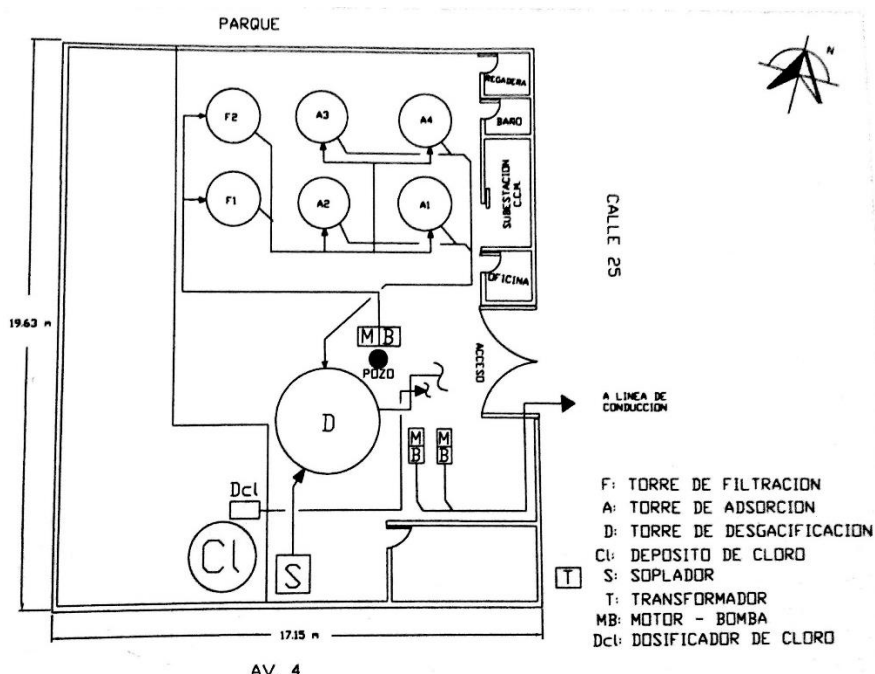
Vista en planta de la PP Iztapalapa 8
